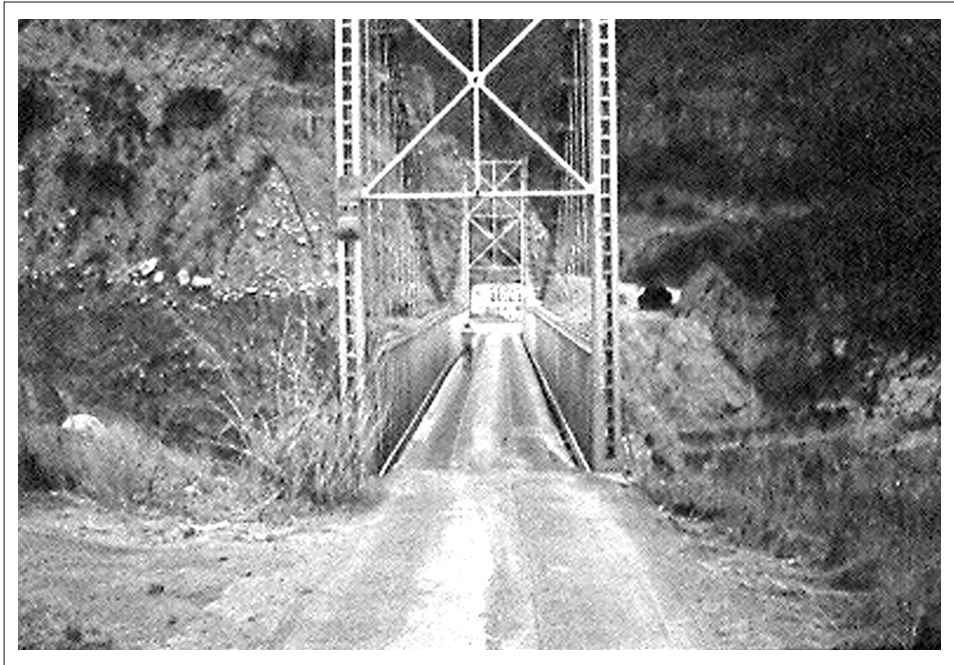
Vista del puente Chichuy desde el estribo derecho; esta obra es de vital importancia para el acceso a los pueblos del sur del estado. Esta estructura constituye, desafortunadamente, un magnífico marcador de deformación. Este puente fue refaccionado en el transcurso del año 2003; ello impidió continuar con las mediciones. Las tasas se incrementaban en épocas de lluvias, duplicando y triplicando la velocidad de desplazamiento. El origen de esta deformación, la cual está colapsando el puente, proviene de un deslizamiento incipiente ubicado al noroeste, unos 250 - 300m en la vía de acceso a la estructura. Este movimiento de masa se activó por acción del subdrenaje (tubificación) y se ha venido despegando a modo de 'tajadas'. (Dirección de la fotografía: SSE)
